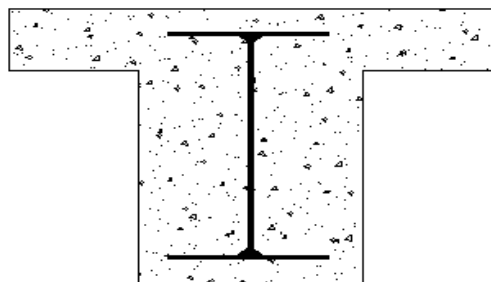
Viga-Mista: Perfil de Aço Mergulhado no Concreto
